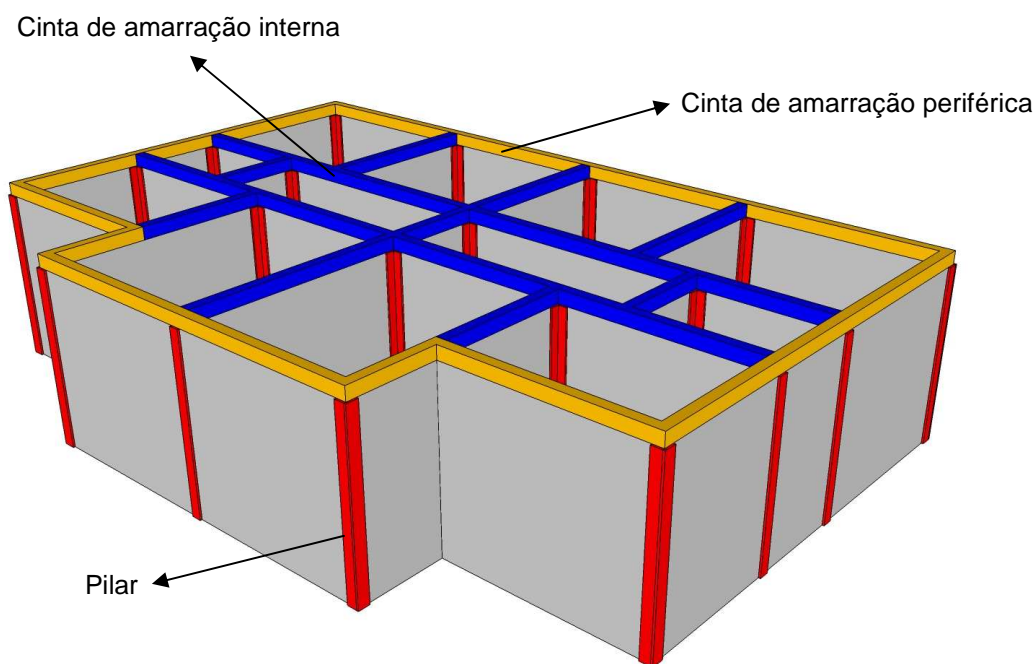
Cintas de amarração horizontais e pilares. Fonte: Ilustração do autor.
